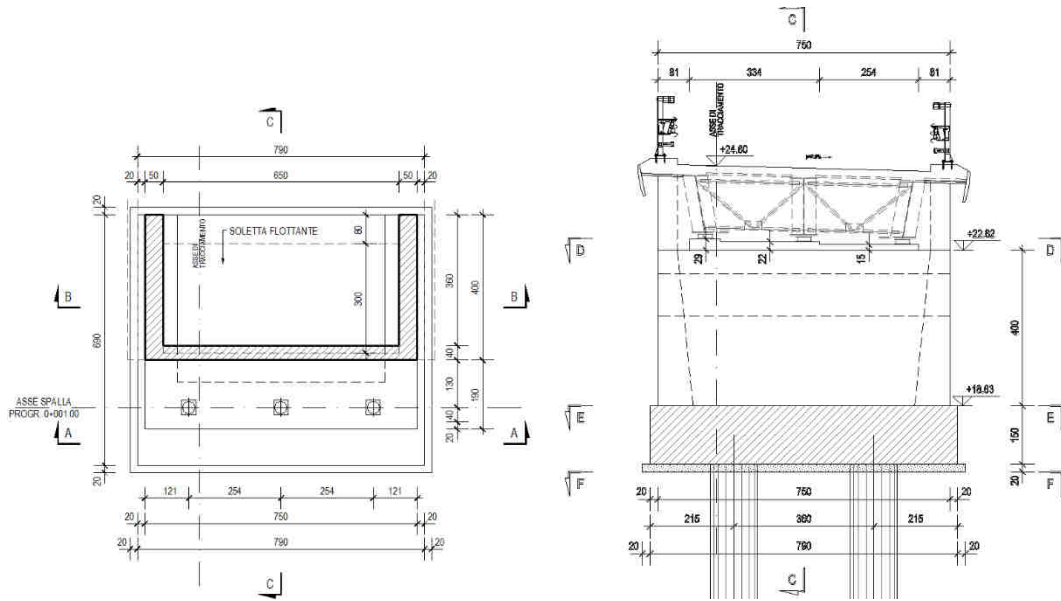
Spalla 1 – Pianta e prospetto
